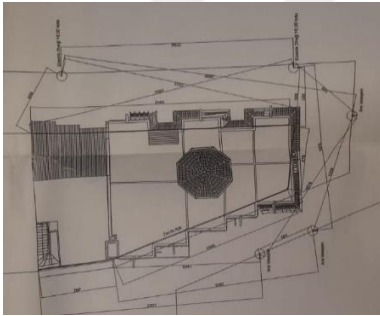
Kat Planı(Anıtlar Kurulu,2008)
